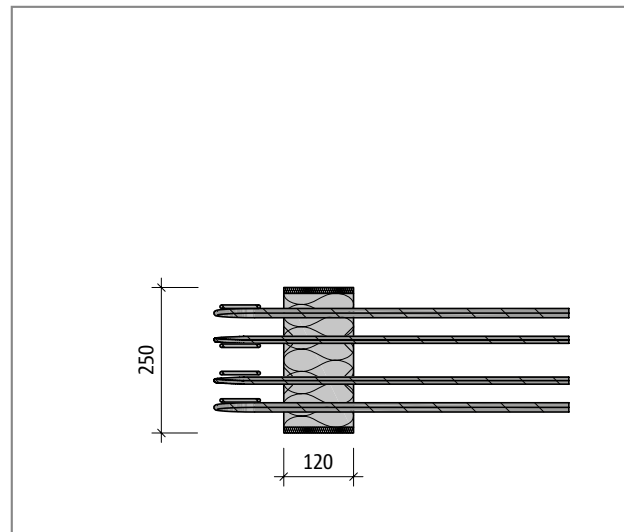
Schöck Isokorb® XT Typ F bei REI120: Produktgrundriss; Brandschutzplatten seitlich
